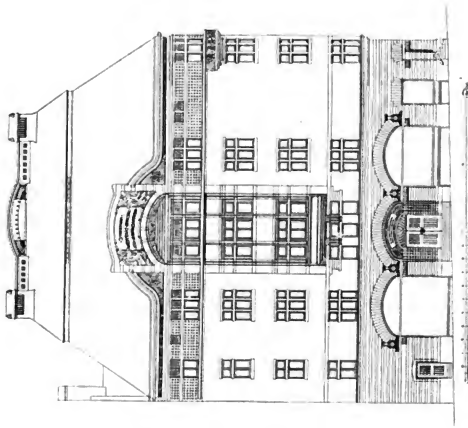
Fassadenpartie des Westeras — Bergslagen-Gebäudes, Stockholm.
